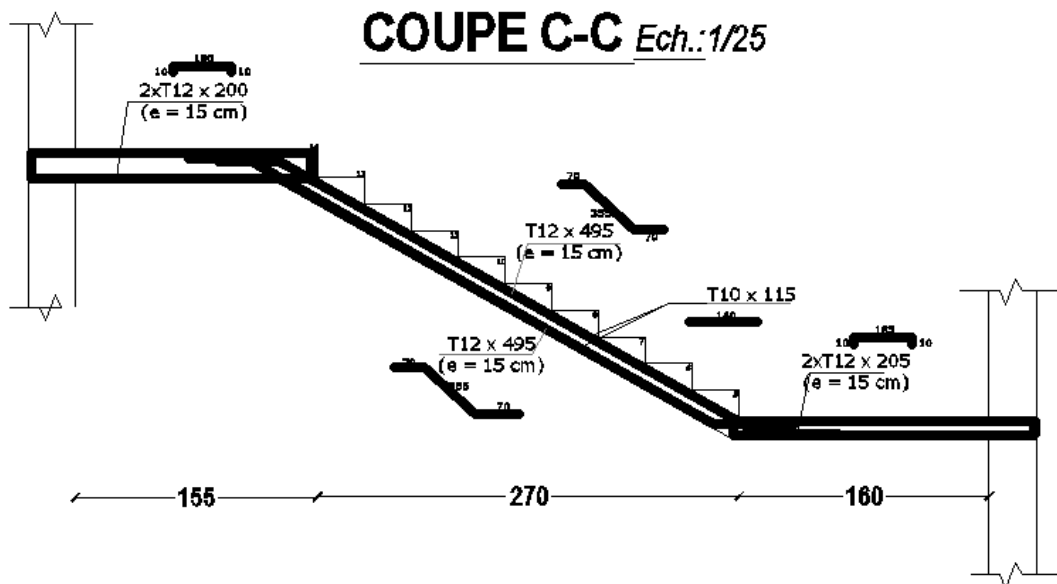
Ferrailage de escalier2 (coupe c-c)
